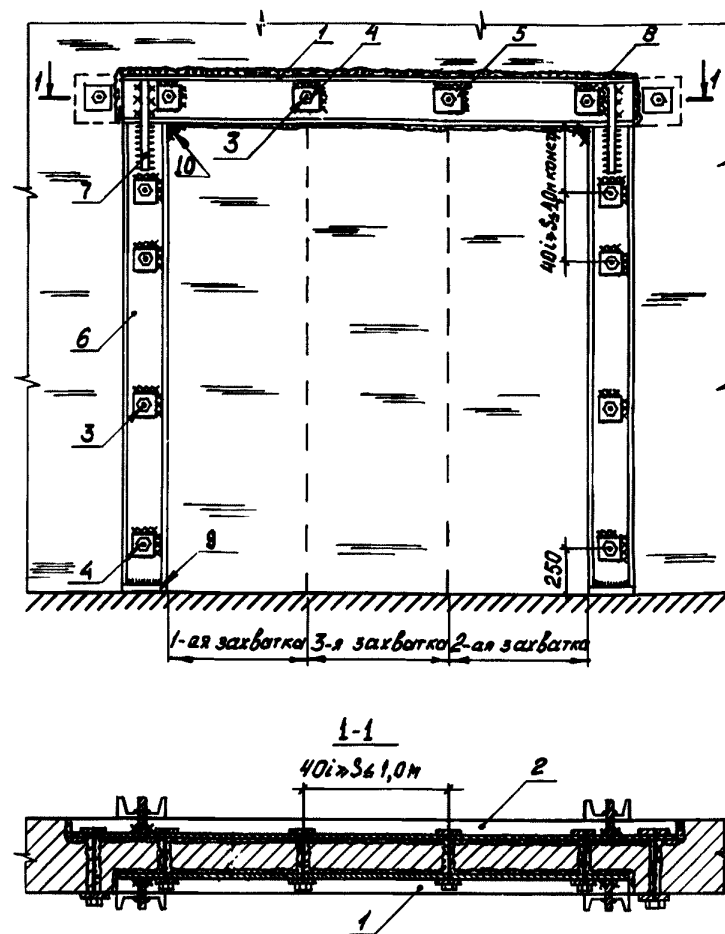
Временное крепление при перекладке стен и устройстве проемов:
